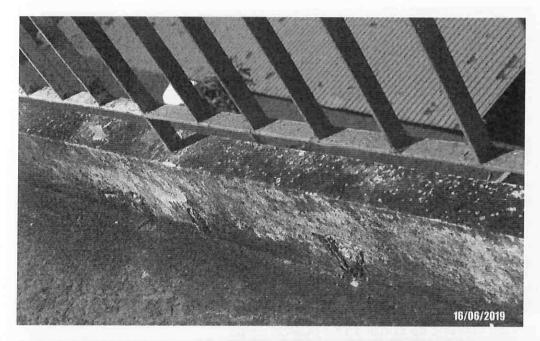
Detalhe da armadura exposta na mureta de fixação do G.C.
